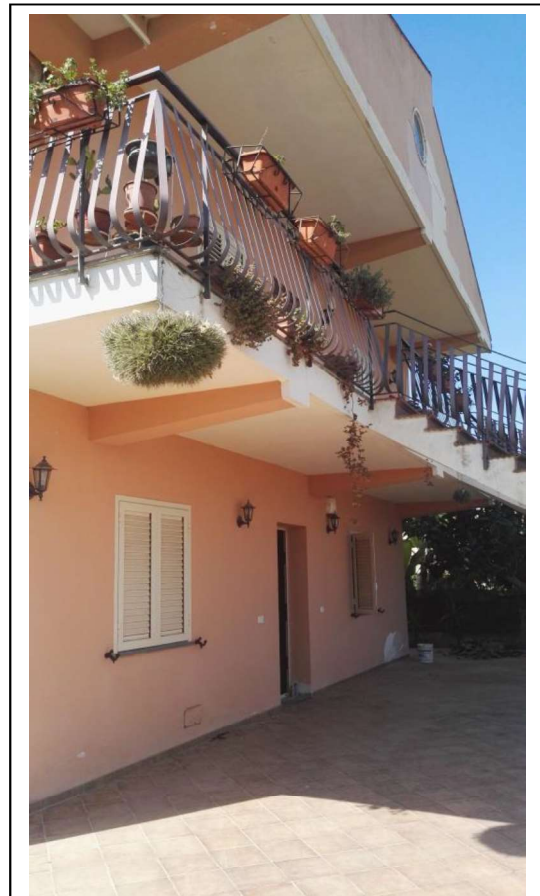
Prospetto Nord su stradella privata di accesso
